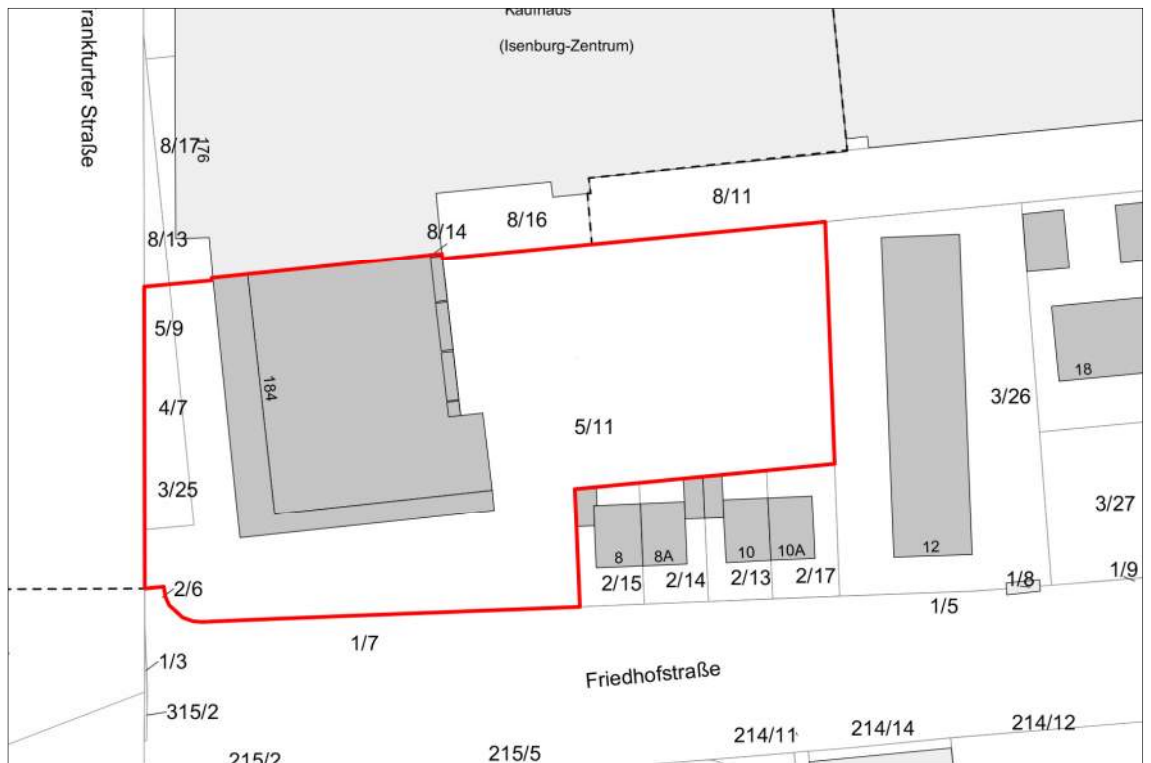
Lageplan, Maßstab 1:500 (Eigene Darstellung / Kartengrundlage: Katasterplan Stadt Neu-Isenburg, Stand Mai 2020)
